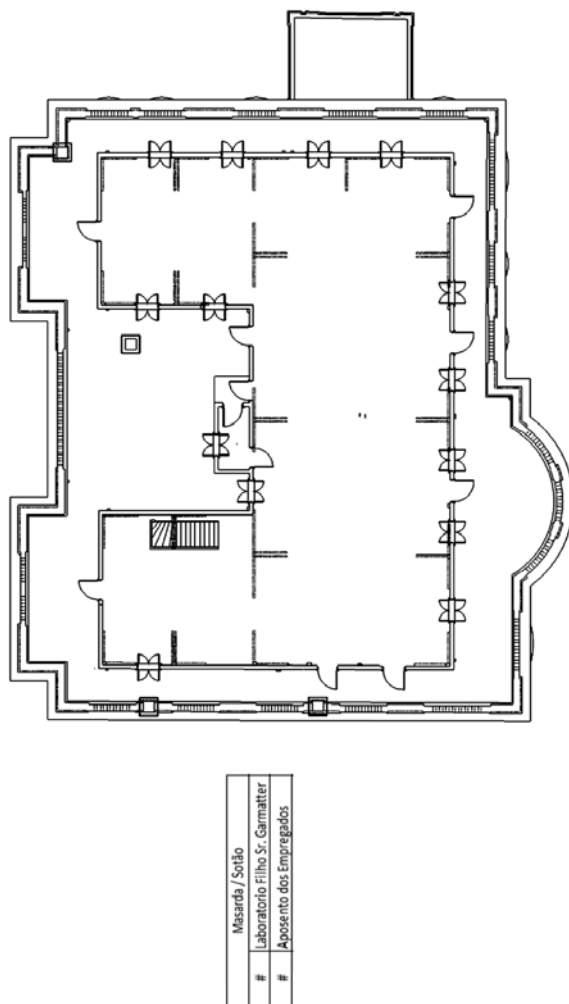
Planta baixa sótão palacete Garmatter.⁵⁴
